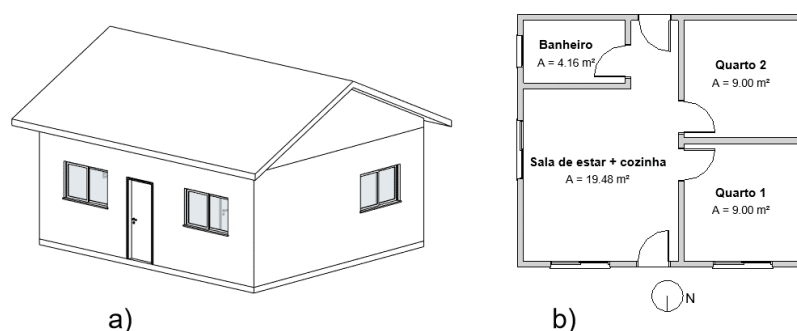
Estudo de caso – Vista 3D e planta baixa.
